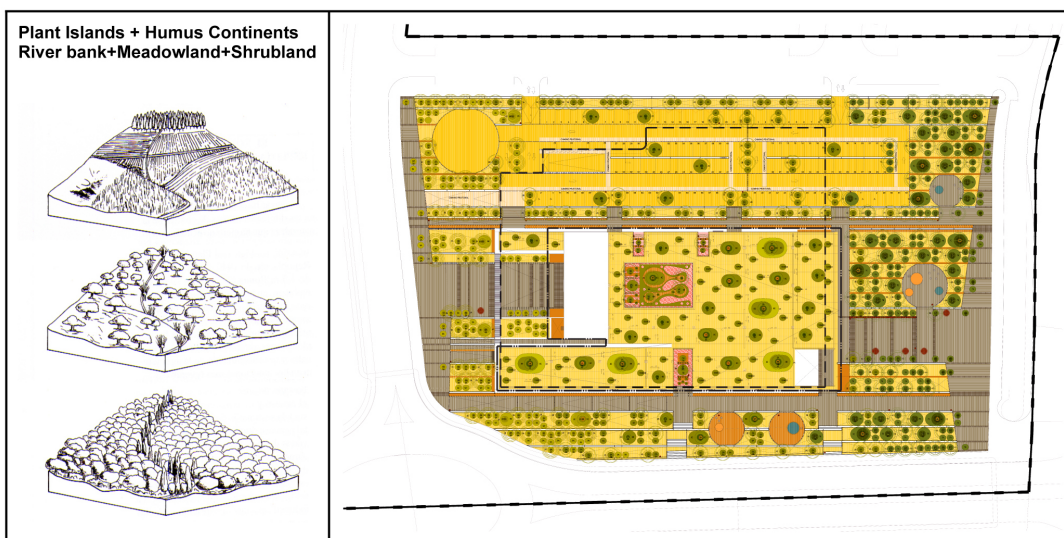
Plano llave. Dehesa Paisaje Caja de Badajoz, 2011. Proyecto de Arquitectura: Estudio Lamela, Proyecto de Paisajismo: Cristina Jorge. Fase de mantenimiento. Plano de pavimentos. Dehesa Paisaje Caja de Badajoz, 2011. Proyecto de Arquitectura: Estudio Lamela. Plano de Paisajismo: Cristina Jorge..
